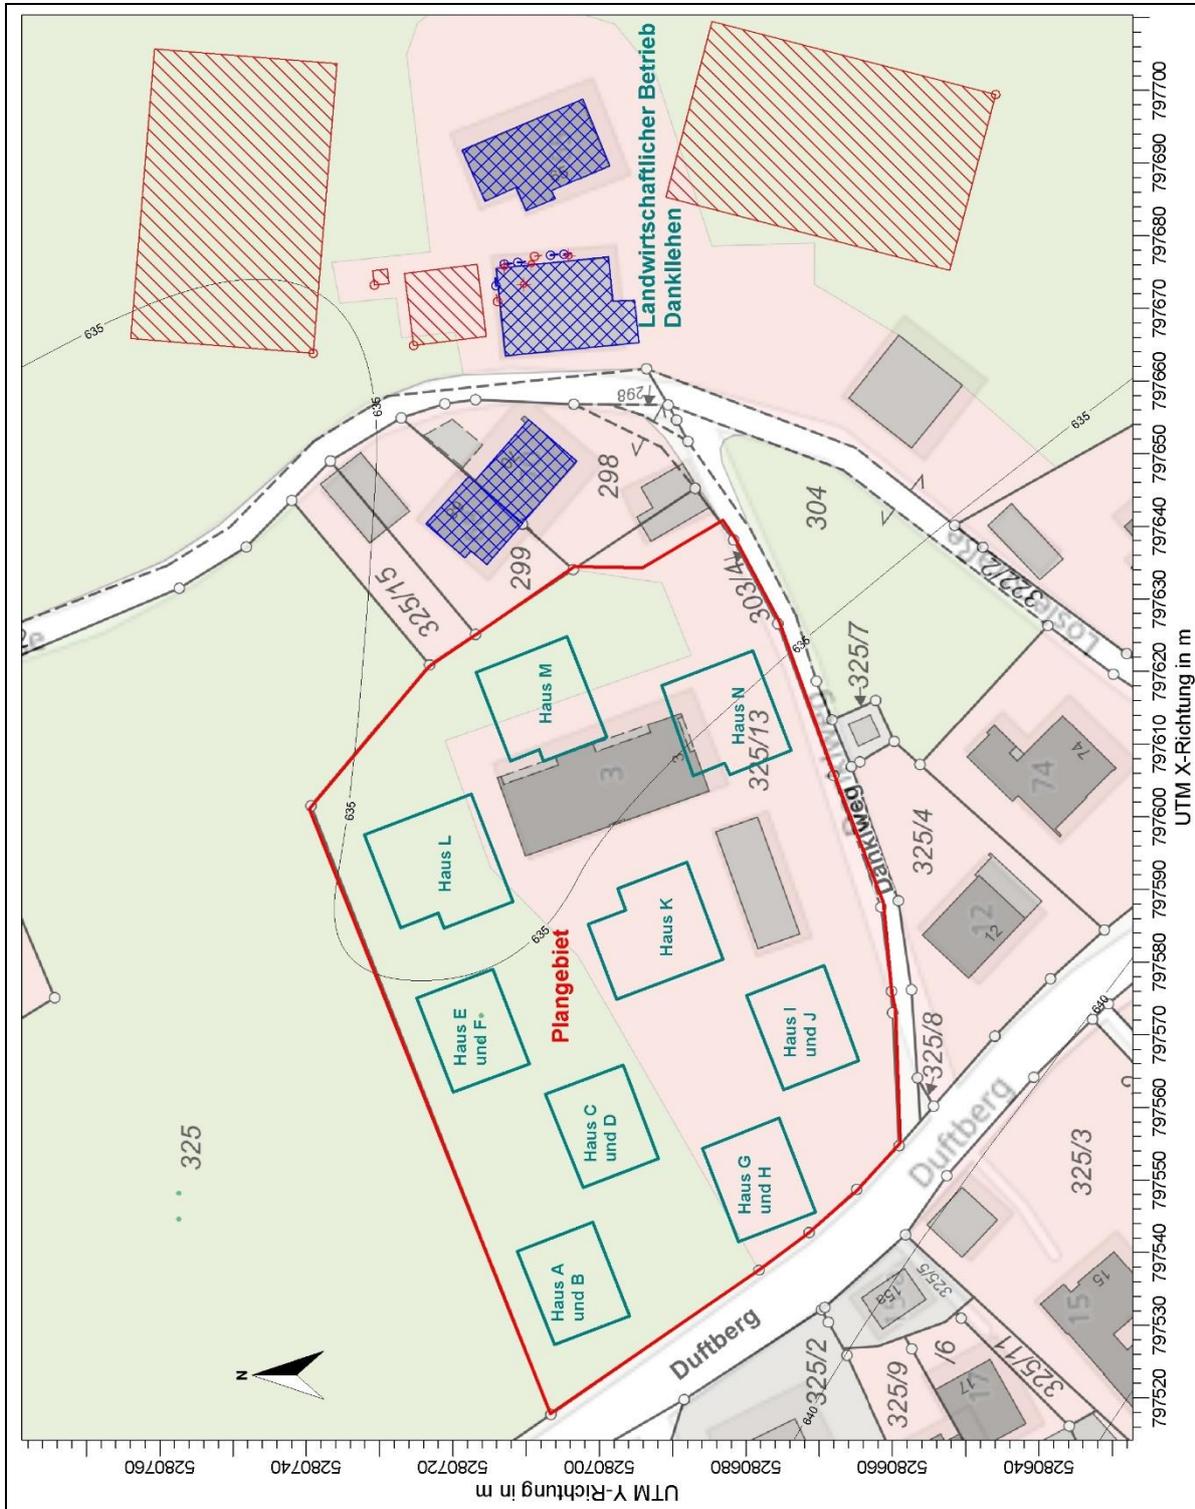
Lageplan Plangebiet und landwirtschaftlicher Betrieb
